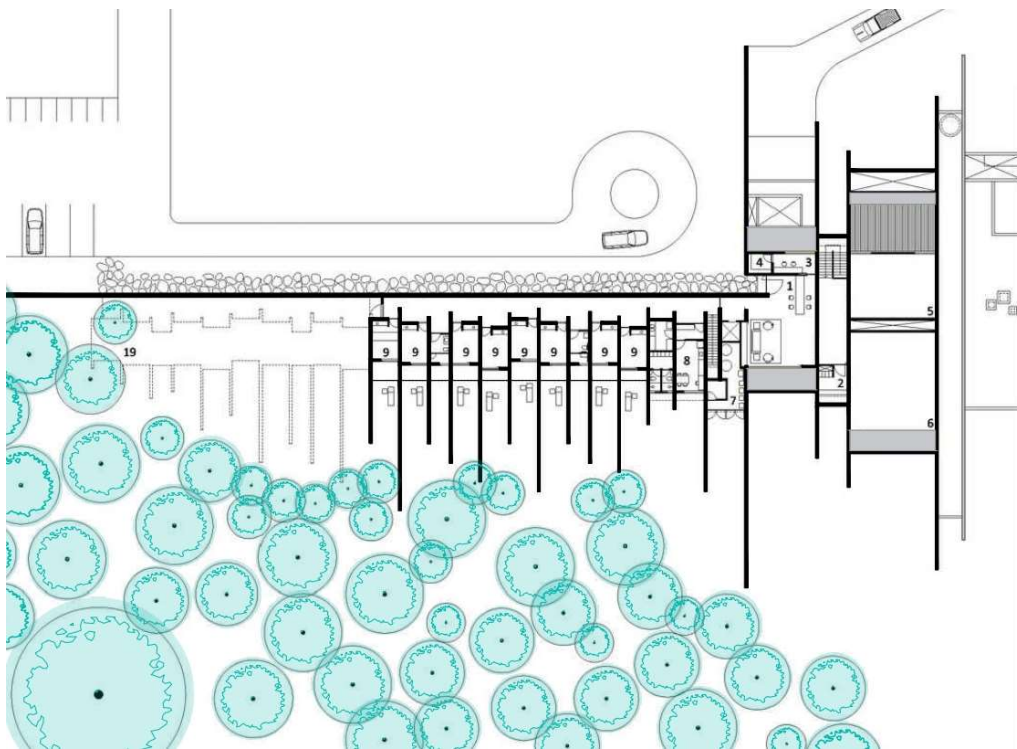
Análisis de precedente 2: planta baja. Elaboración propia.
